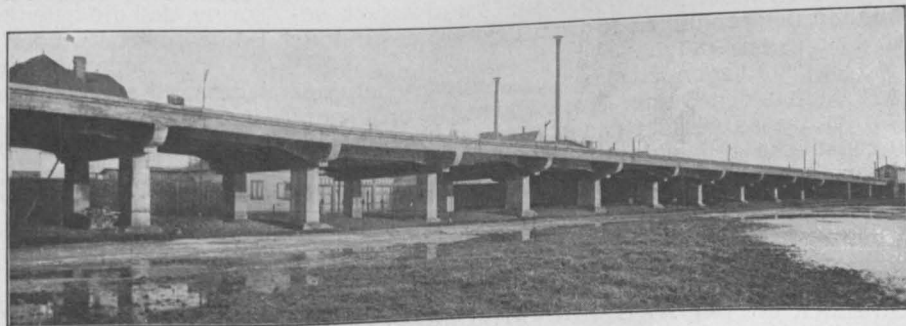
Teilansicht der Ueberführung (Kragträger-Konstruktion).
